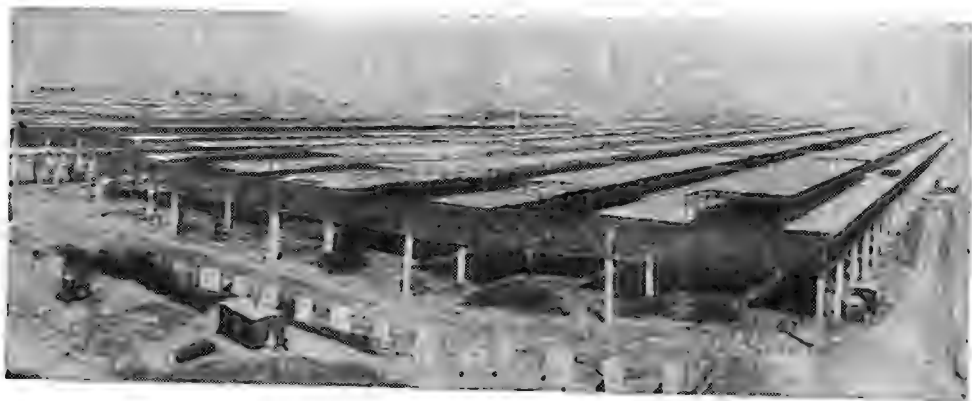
Общий вид главного корпуса ВАЗа в процессе строительства
